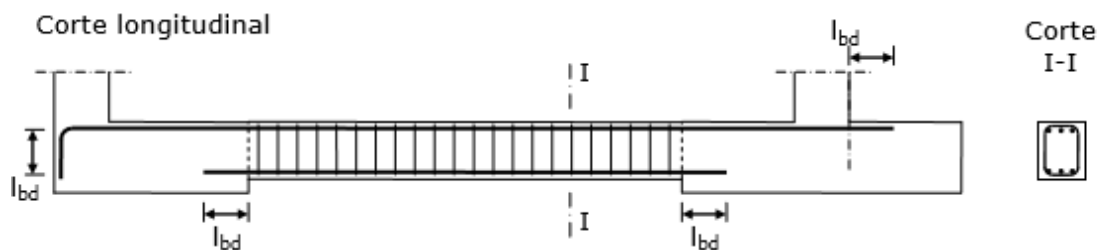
Armadura de uma viga de equilíbrio. (Félix, 2014)
